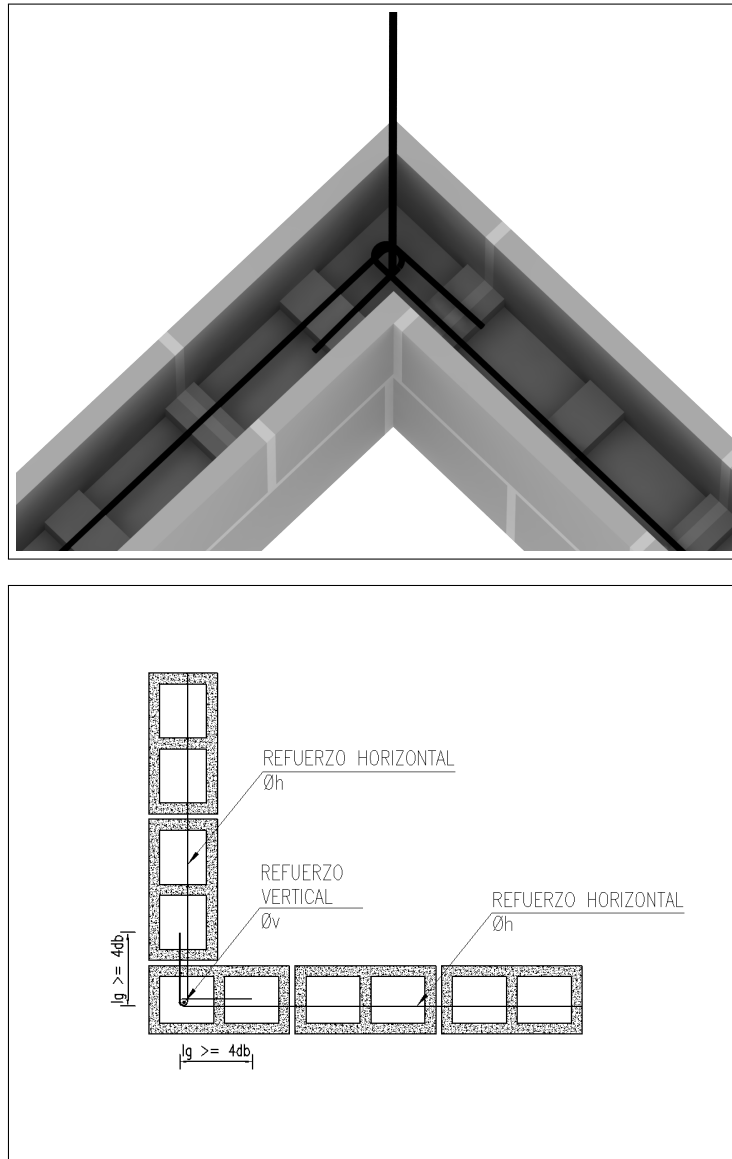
Detalle de las barras de refuerzo horizontal en el encuentro de muros en L.
